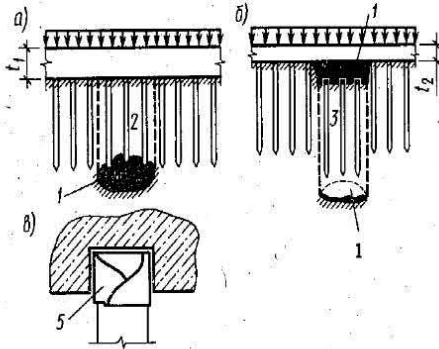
Конструкции свайных фундаментов с жесткой заделкой (а) и свободным соединением свай и ростверка (б); деталь соединения ростверка со сваями (в):
